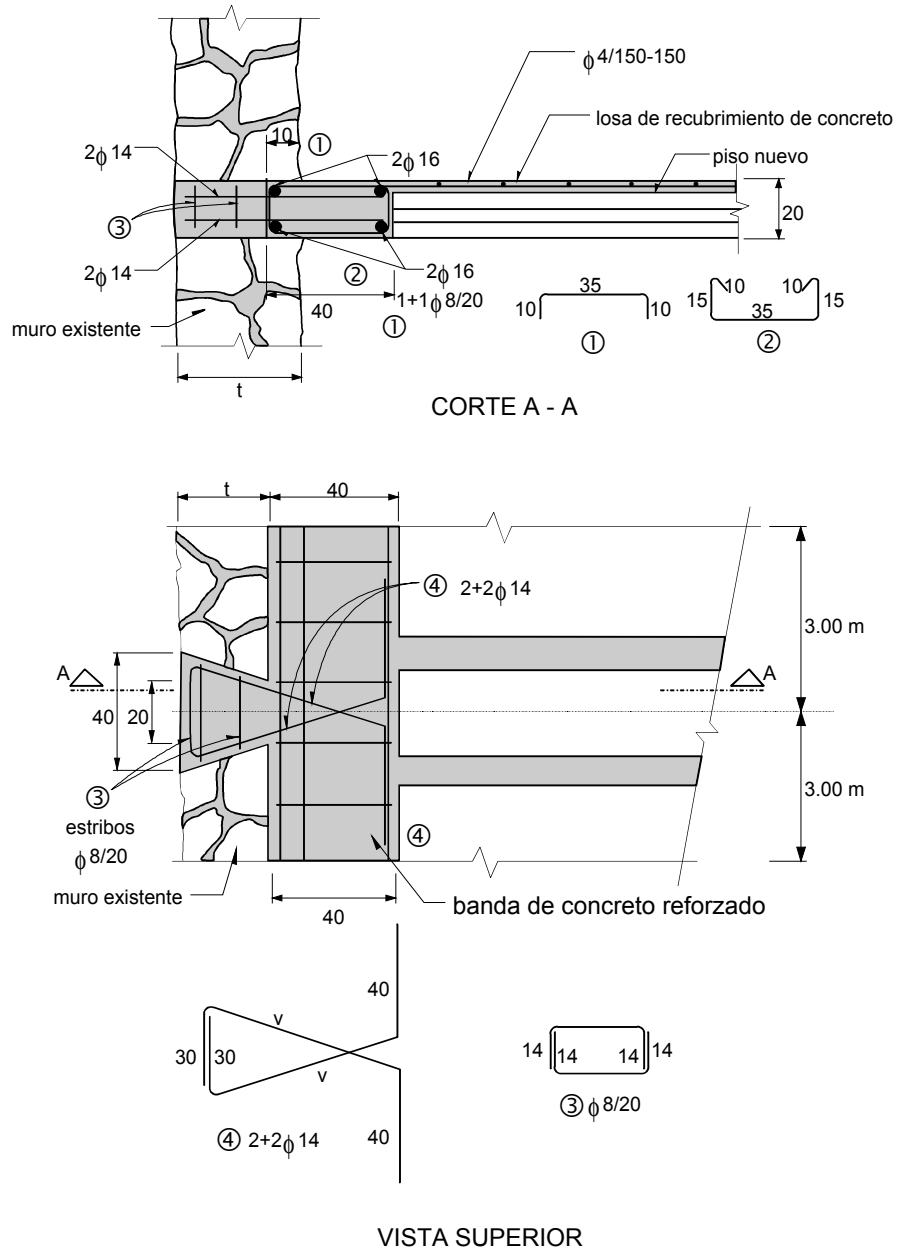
Conexión del nuevo refuerzo de la losa a los muros de carga
